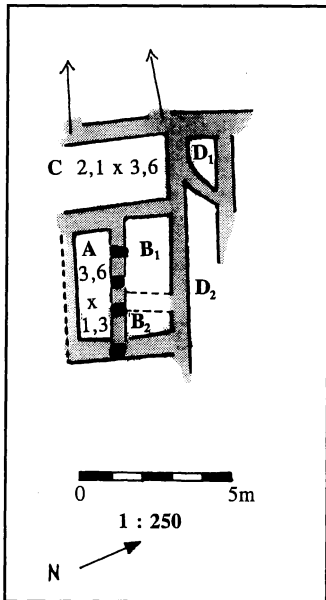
Bētīn: Grundriß Mauerzüge Areal F
